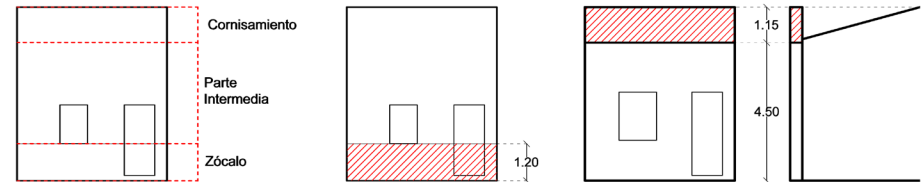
Propuesta Lineamientos Plan Seccional, división de cuerpos.
